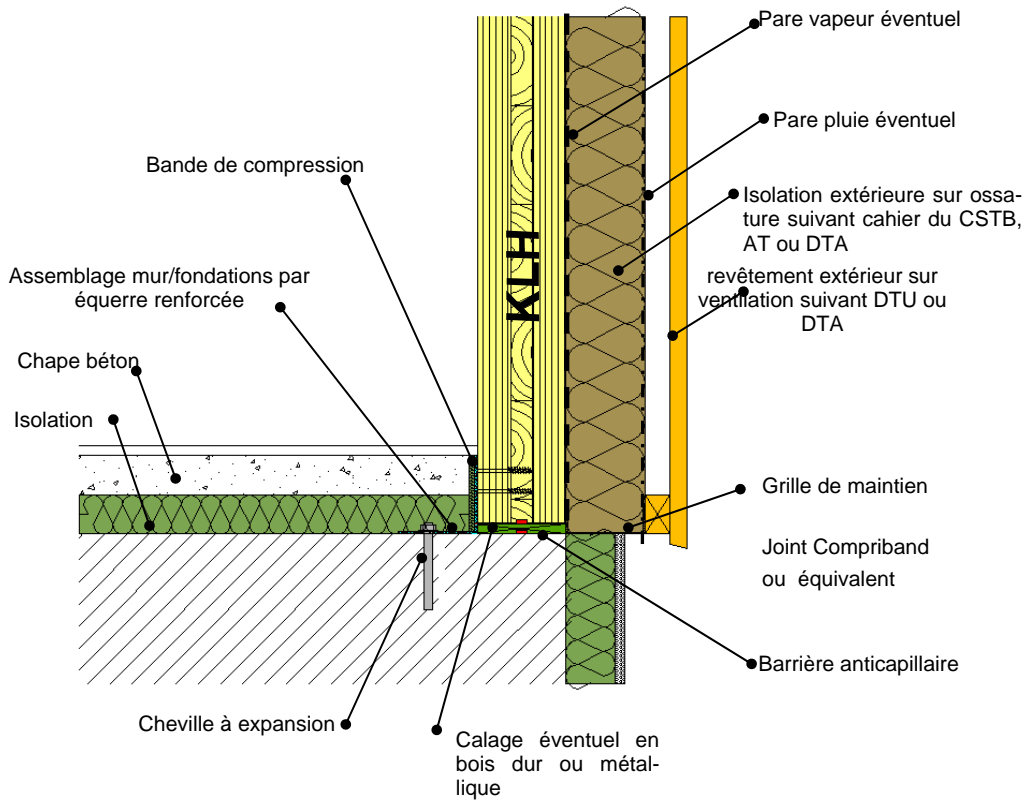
Coupe verticale mur extérieur/dalle béton avec vêtture extérieure
